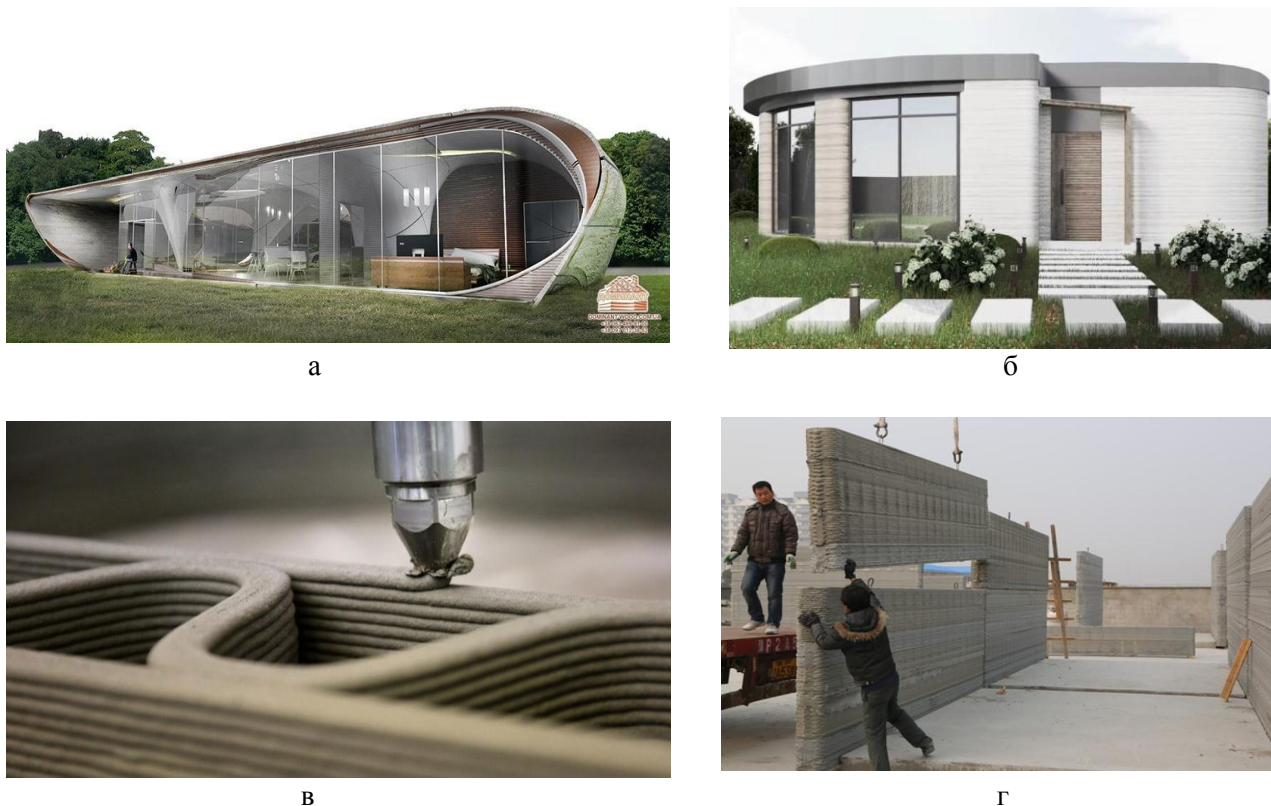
3D- друк будівельних об'єктів: а - б – зведення будівель; в – друкування конструкцій; г – монтаж друківаних будівельних конструкцій
